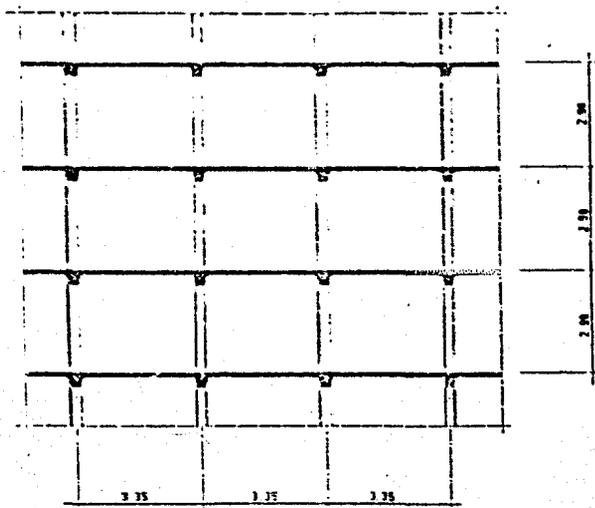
b.—Sección longitudinal con las placas de forjado en -U-.
